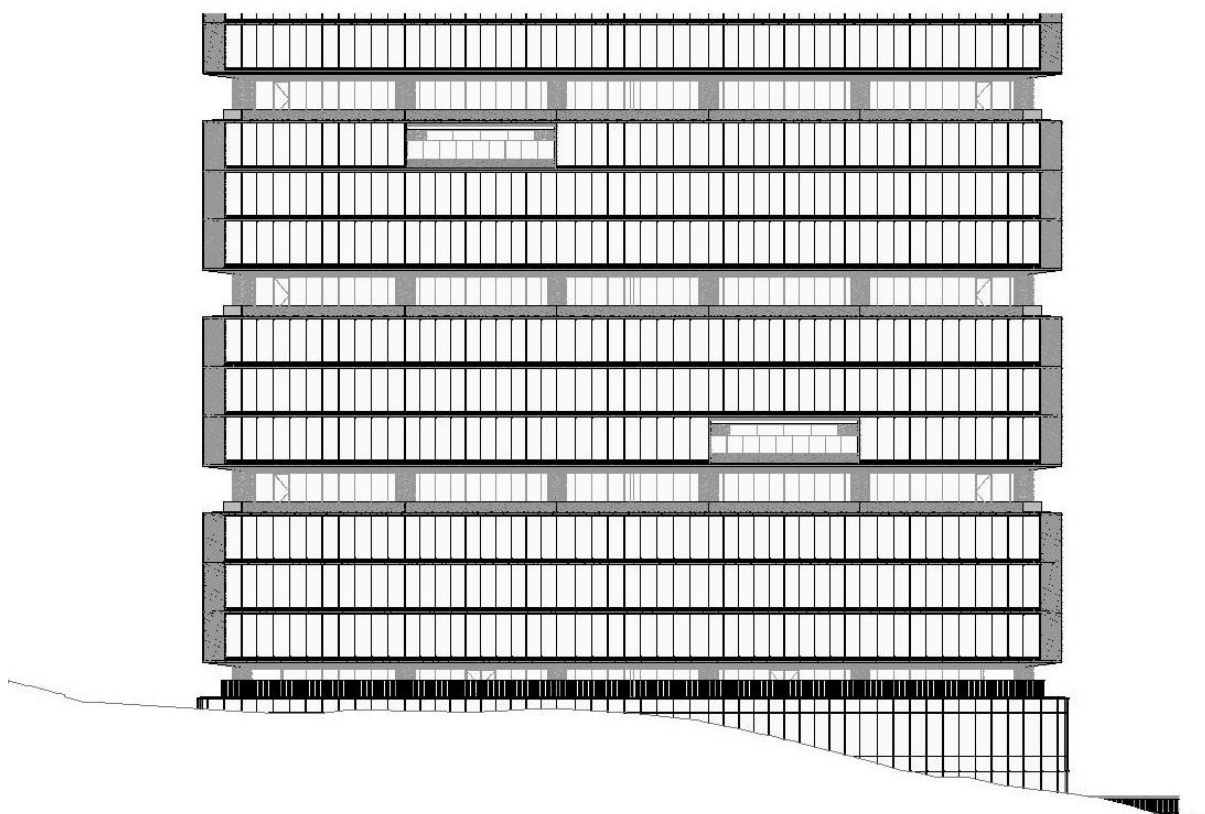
Fachada B / Direita (Sul) do Edifício Lótus Tower.
